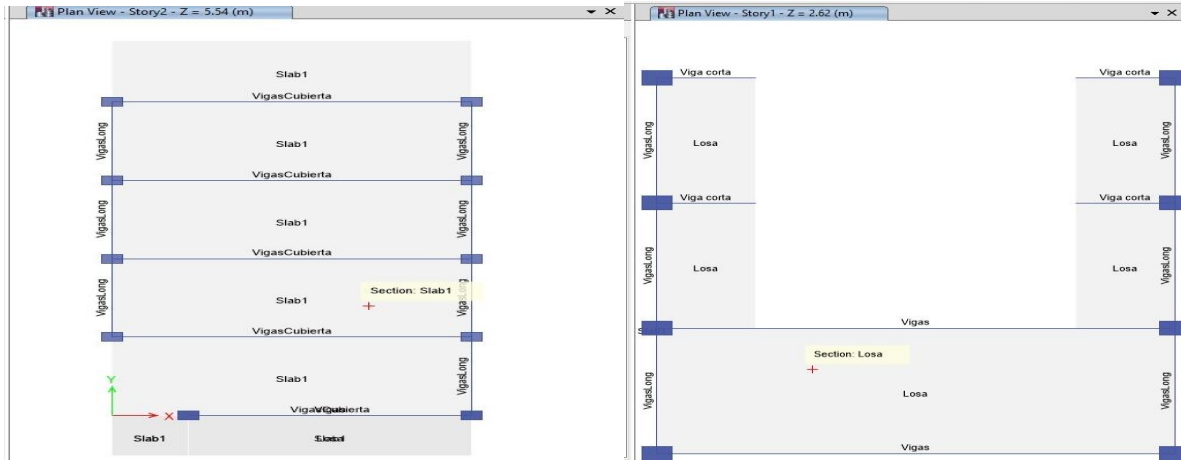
Plantas y elevación representando detalles de secciones de columna, vigas y losas.
